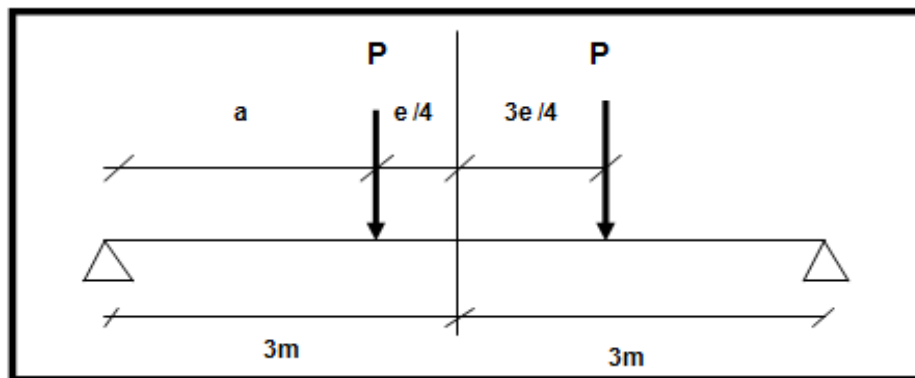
Illustrations des efforts appliqués sur la poutre de roulement par le galet avec P la réaction verticale max
